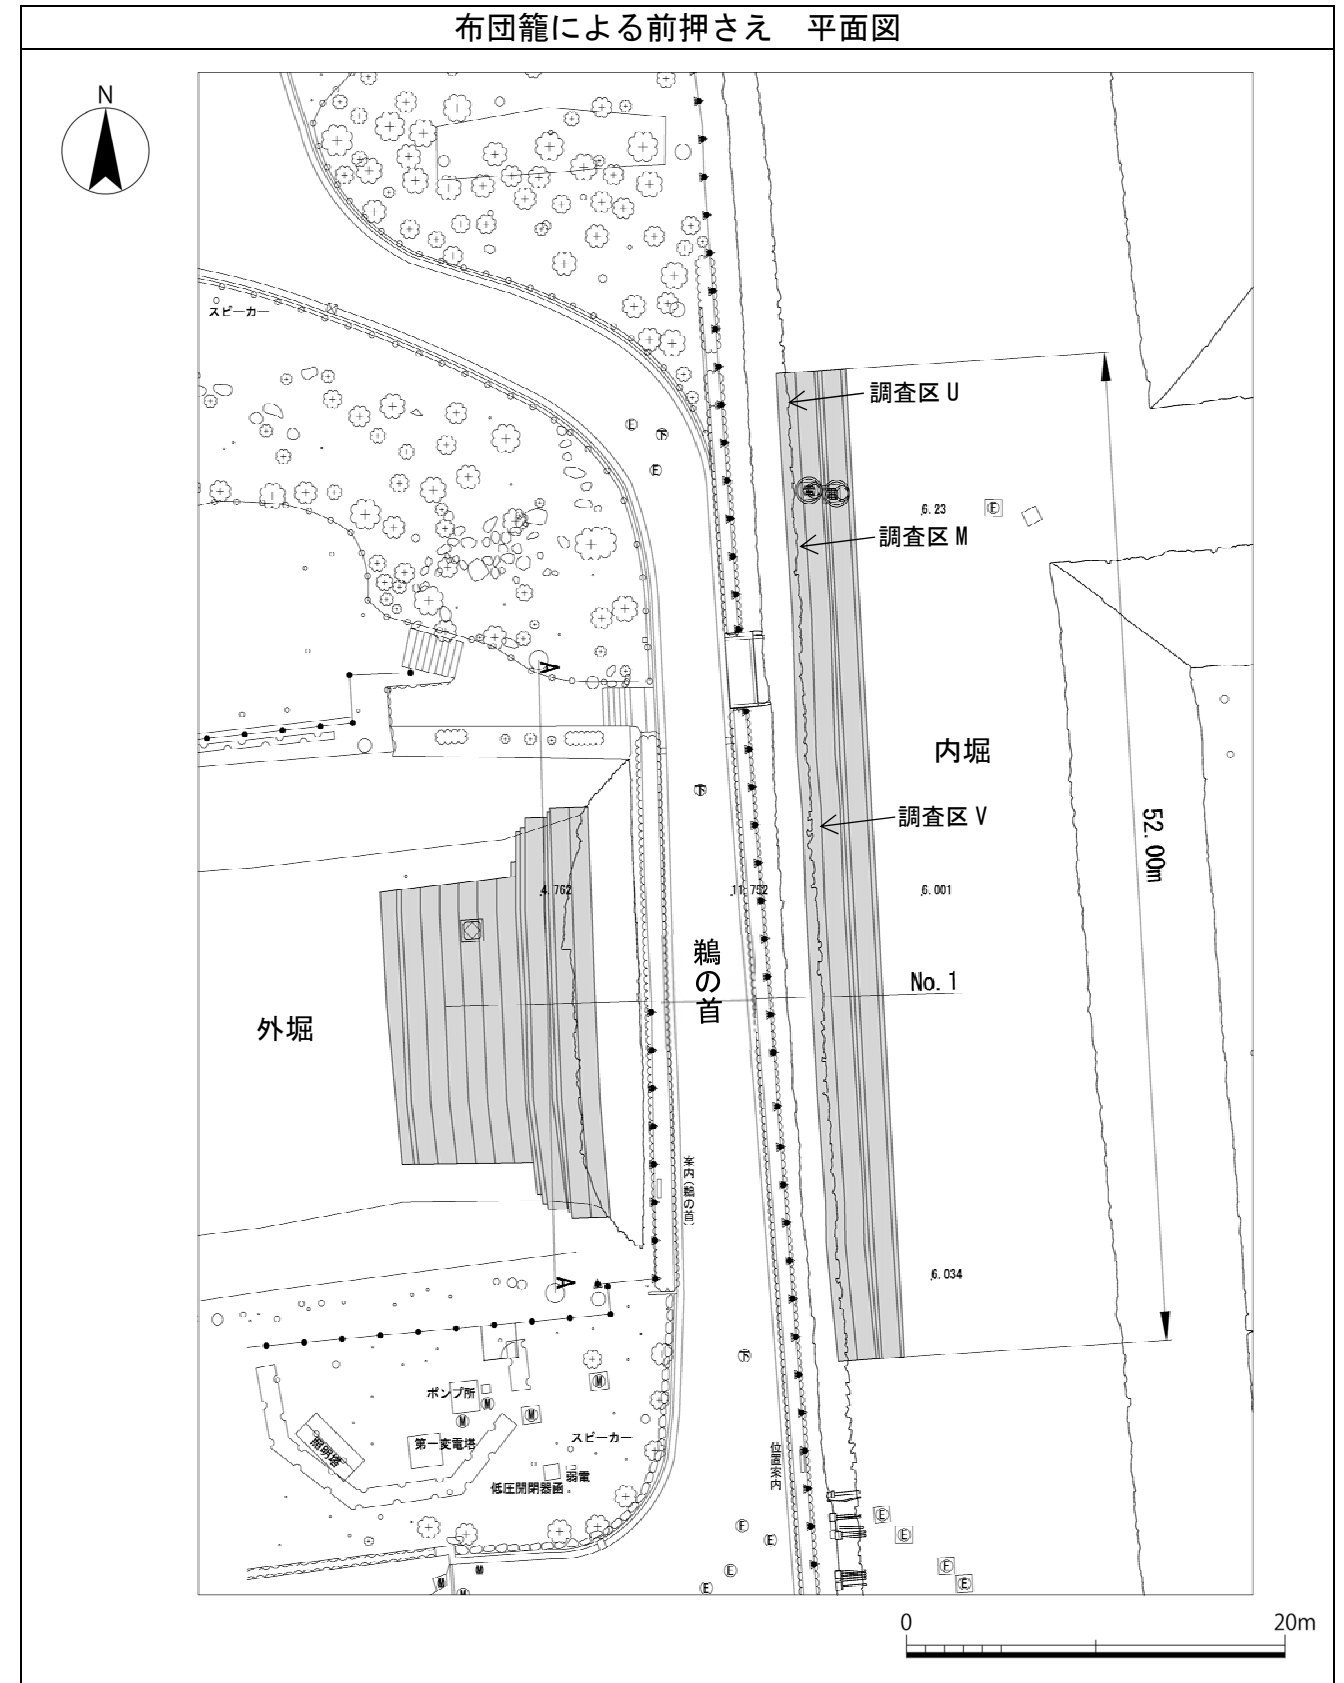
布団籠による前押さえ対策（U66、S10）平面図 1/400
